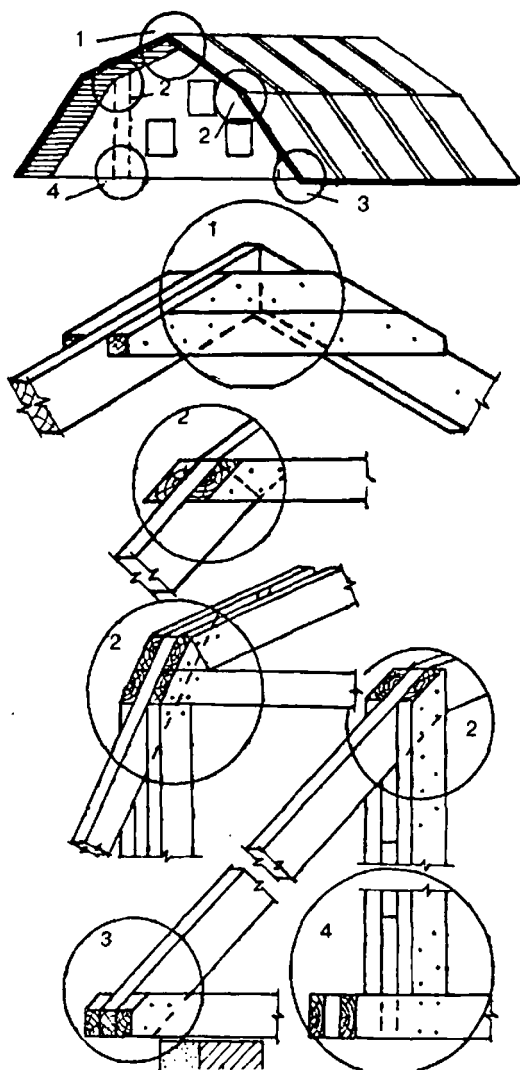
Основные типы соединений стропильных конструкций при обустройстве мансарды в ломаной крыше
